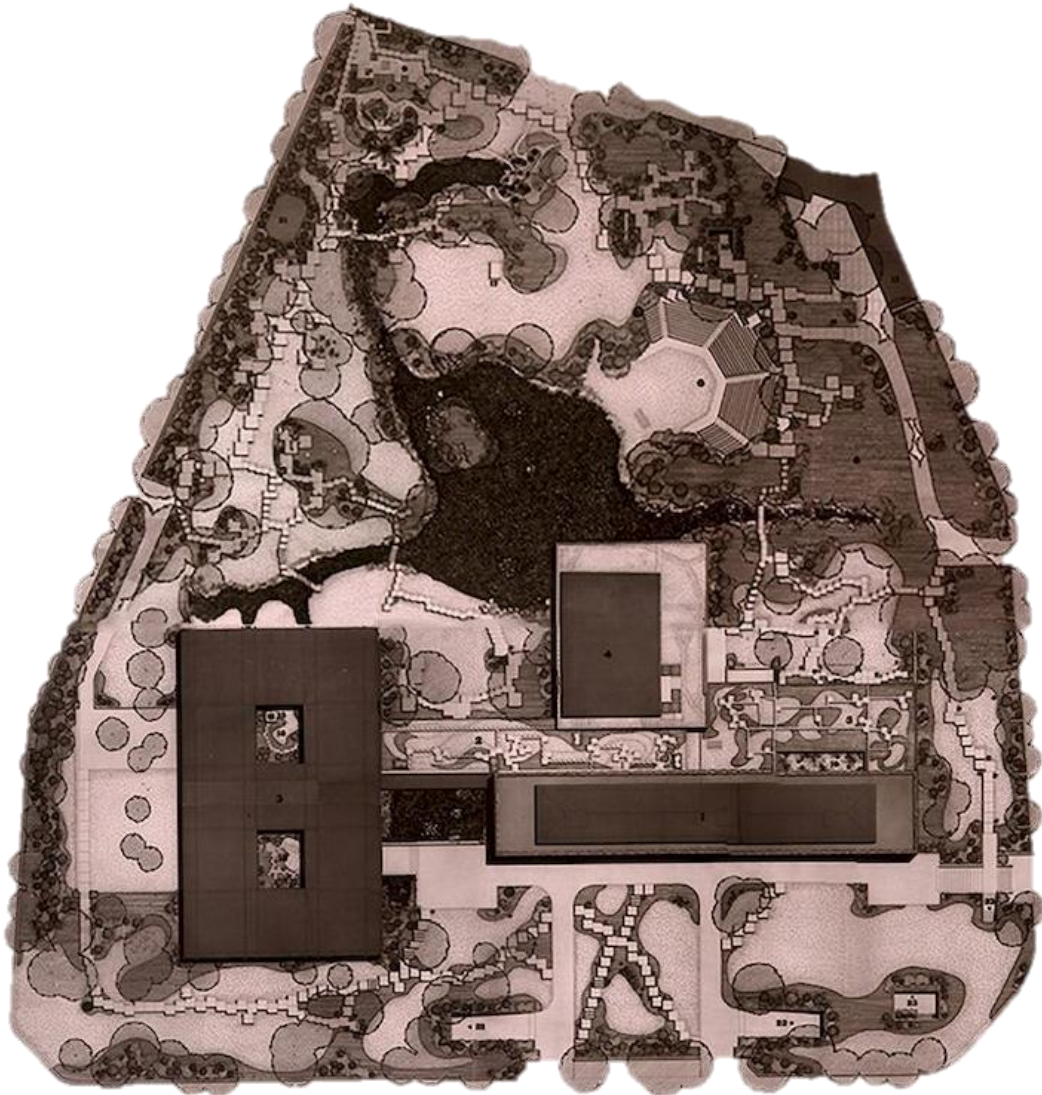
Planta da Fundação Calouste Gulbenkian de 1969 – Gonçalo Ribeiro Telles
